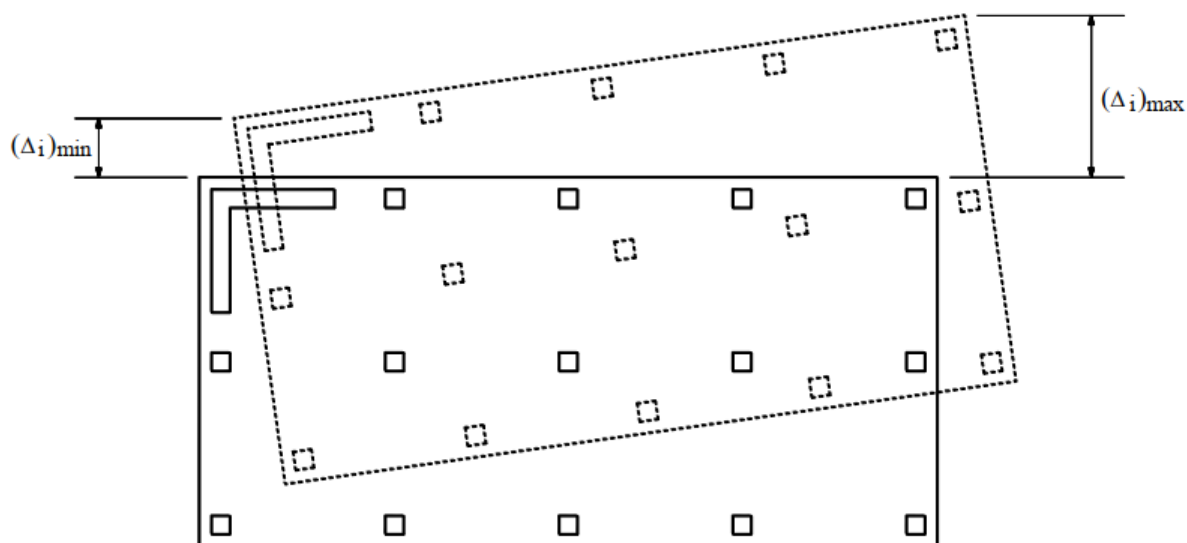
К проверке горизонтальных перемещений в уровне перекрытий
